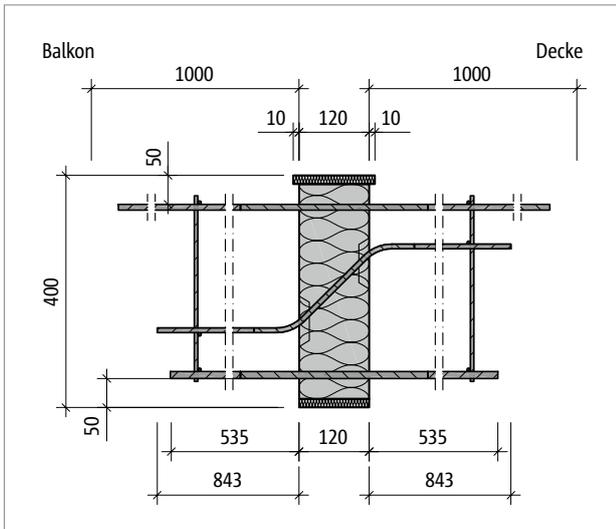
Schöck Isokorb® XT Typ B: Produktschnitt
